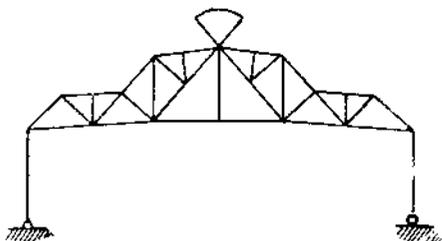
представляет собой пример перекрытия пролета в 40 м металлической фермой типа фиг. 239, при чем к ферме, к нижнему поясу, подвешены опоры для кранового оборудования.
